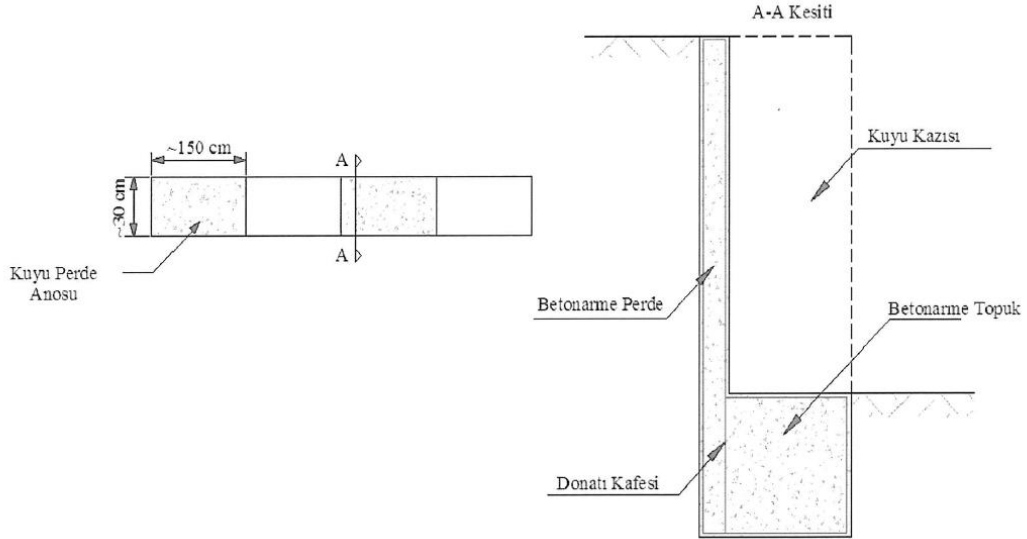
Betonarme Perde Duvarlı Kuyu Temel
